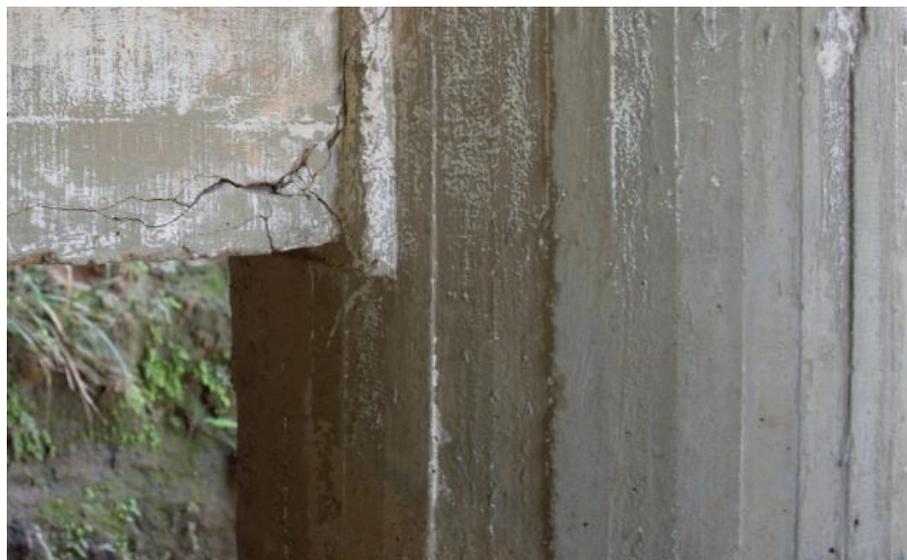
Vista da mesoestrutura da Ponte 1 (lado inicial). Detalhe para destacamento da argamassa da laje.
